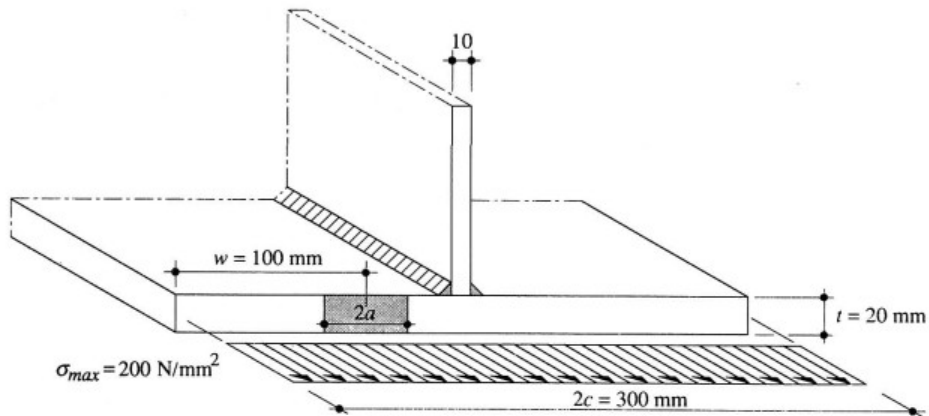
Section de poutre composée à âme pleine avec une fissure traversante dans la semelle.
